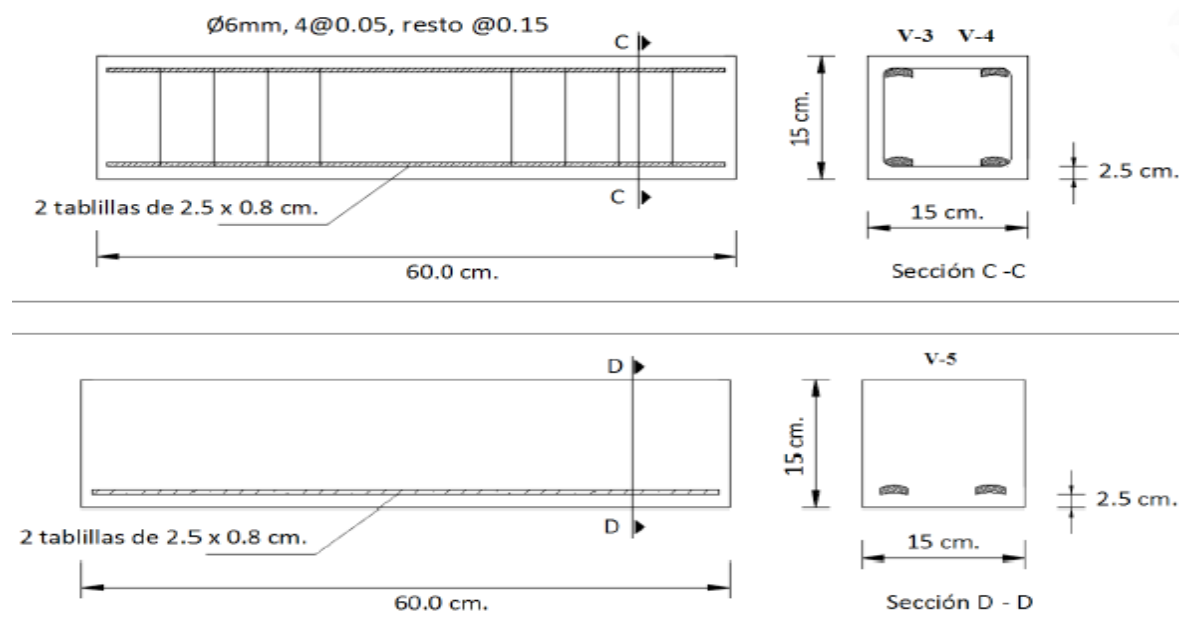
Vigas de concreto reforzadas con tabilla de bambú, con o sin estribos (cuantía 2)
